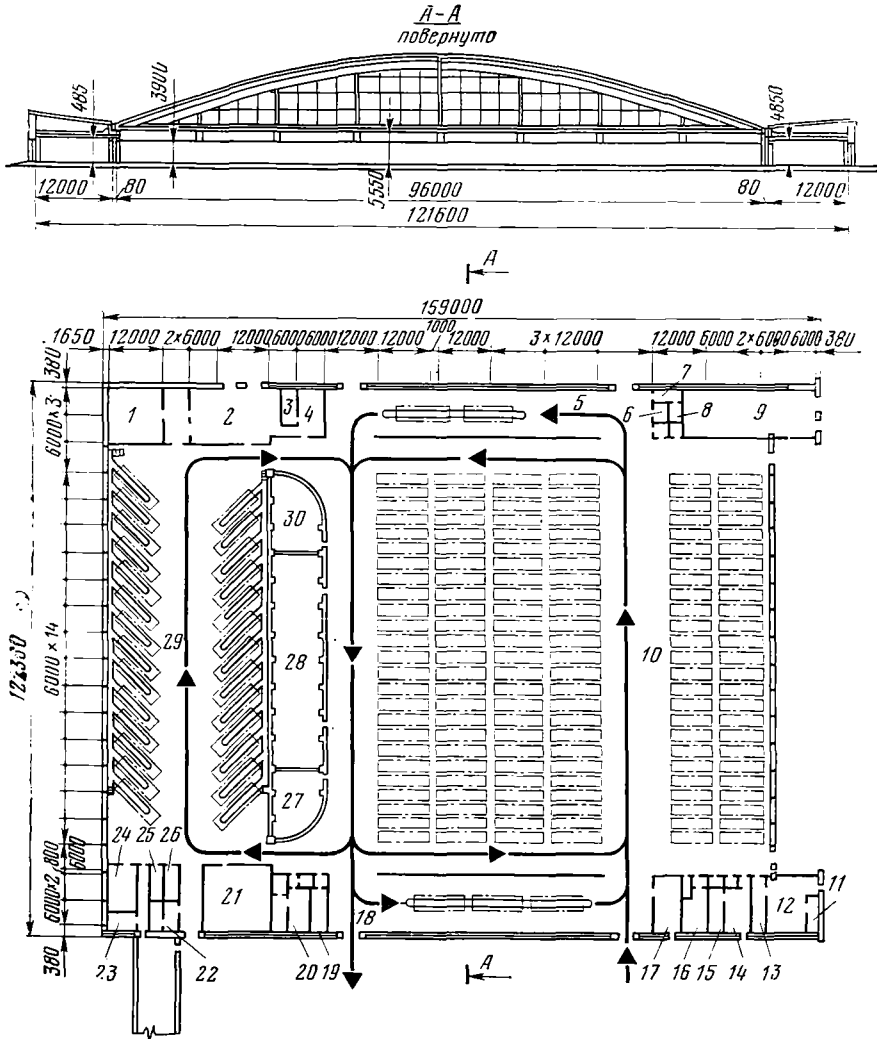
Планировка производственного корпуса АТП на 500 автобусов с покрытием из сводов цилиндрического (бочарного) типа:
